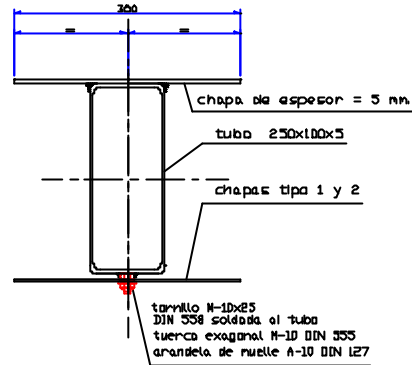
Montaje de las chapas anterior y posterior sobre el pilar.
